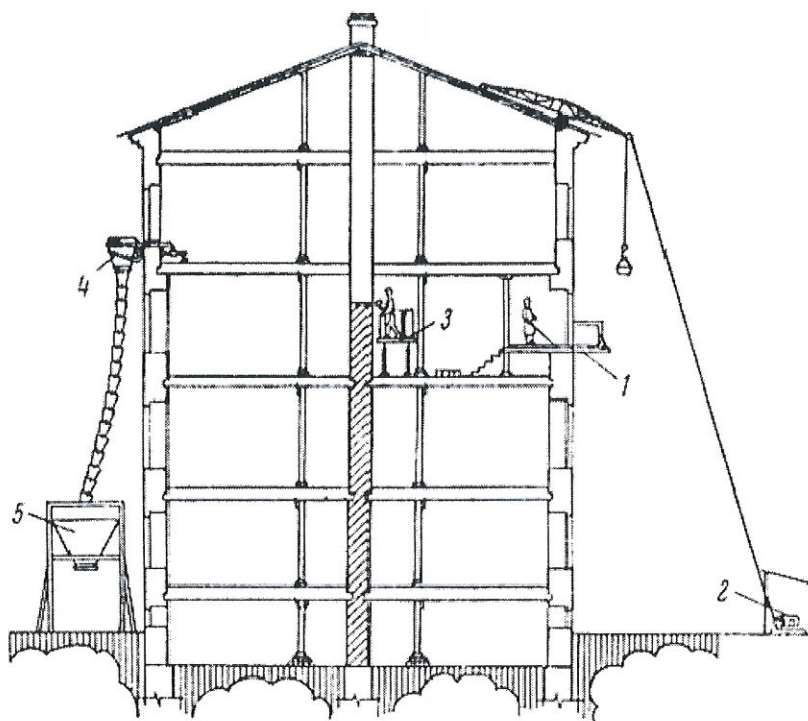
Общая схема организации работ по перекладке участка стены с сохранением существующих перекрытий
